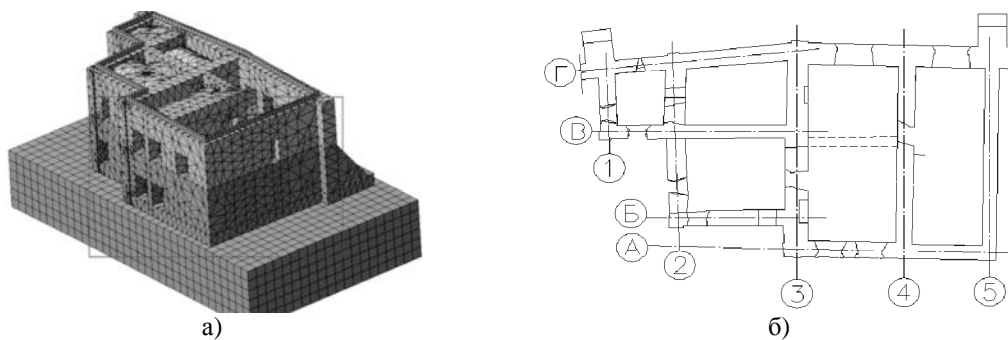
Здание монастырского училища: а) расчетная схема; б) план
